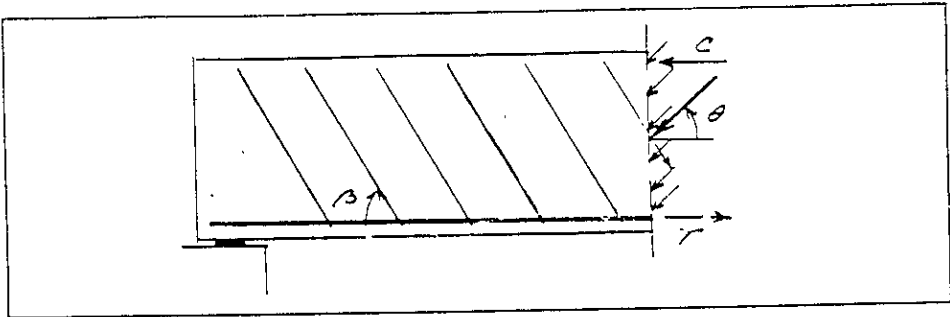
Definición de ángulo de los puntales y ángulo de los estribos
